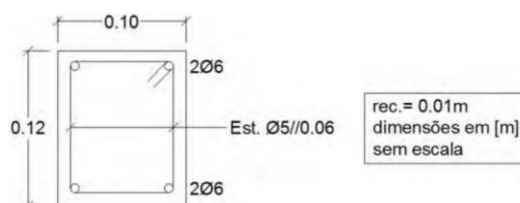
Pormenorização de armaduras numa secção genérica das vigas. (Adaptado de [20].)
